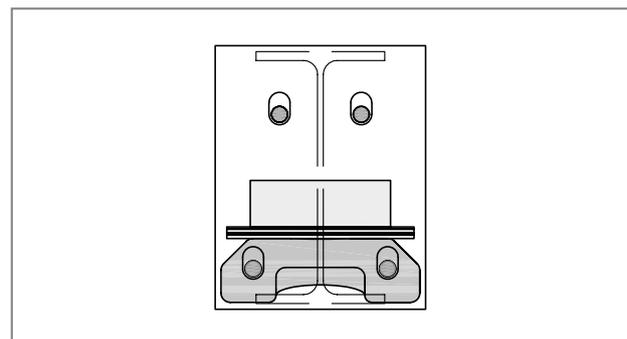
Schöck Isokorb® T type SK: Adding design shims on the load plate will raise the steel beam by up to 20 mm
